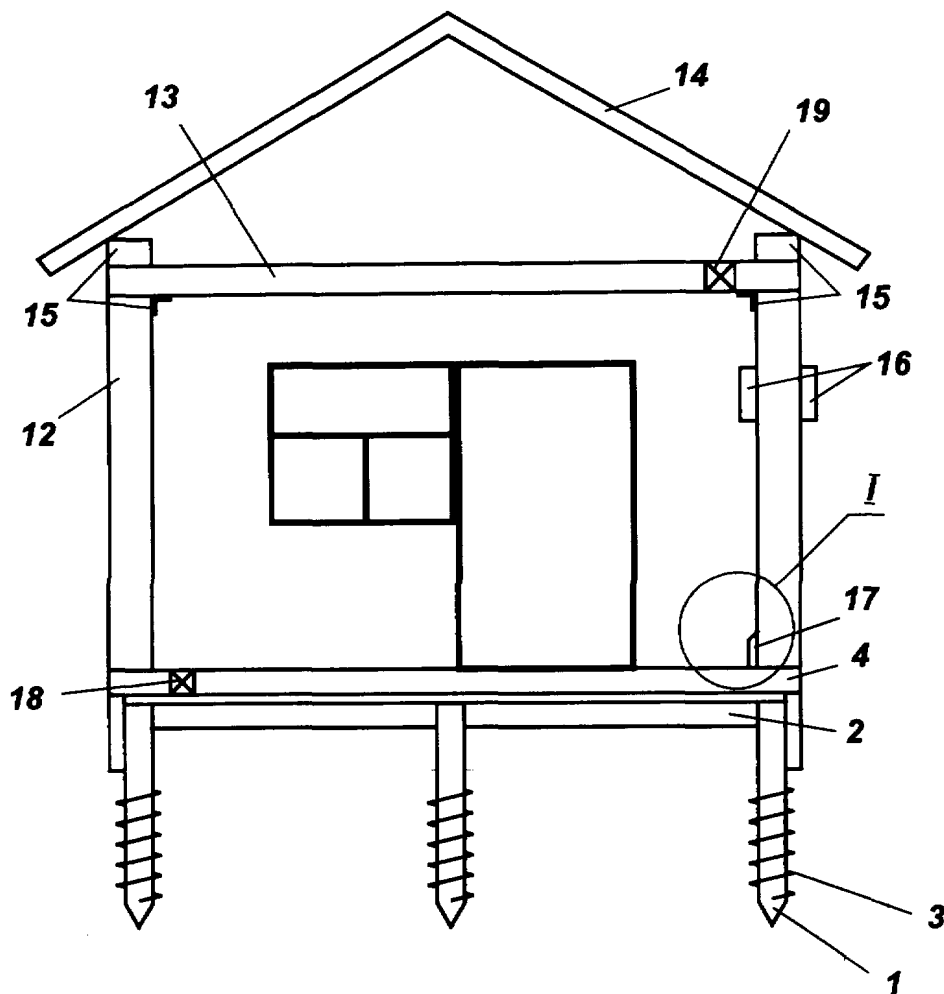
Фронтальный вид здания с фундаментом из винтовых свай и фрагмент стены с обвязочной балкой по верхнему и нижнему торцу панели [1]:
